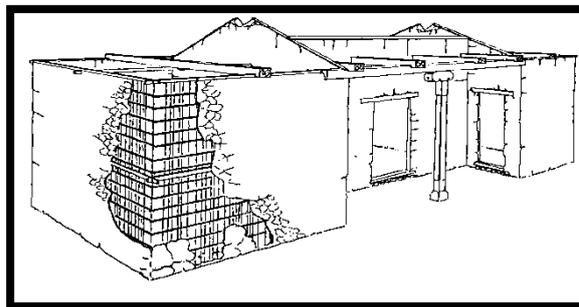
Vivienda de Bahareque de Vilcabamba
